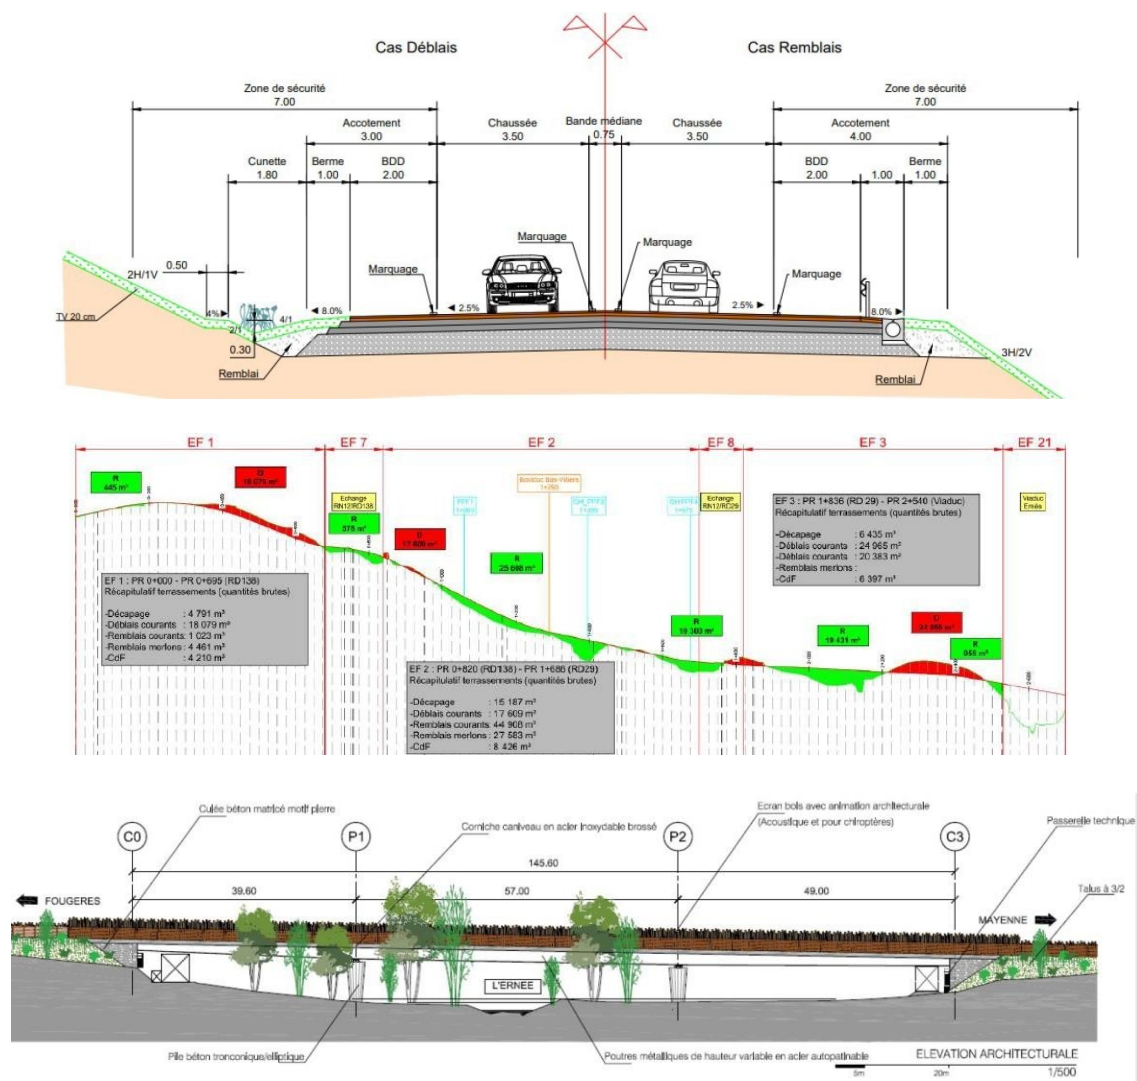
illustration du travail effectué : profil en travers de la section neuve hors créneaux de dépassement, profil en long faisant apparaître les déblais (en rouge) et remblais (en vert), le viaduc – source : dossier
